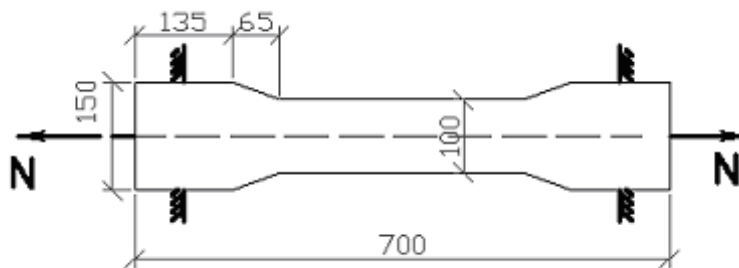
Схема випробування зразка для визначення міцності бетону при осьовому розтягуванні на розрив
